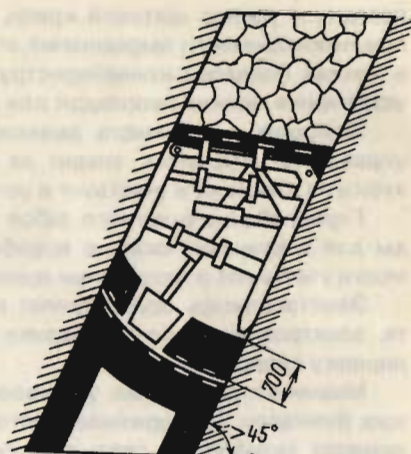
Схема зарубки исполнительного органа в пласт у кровли забоя на полный ход гидродомкрата
